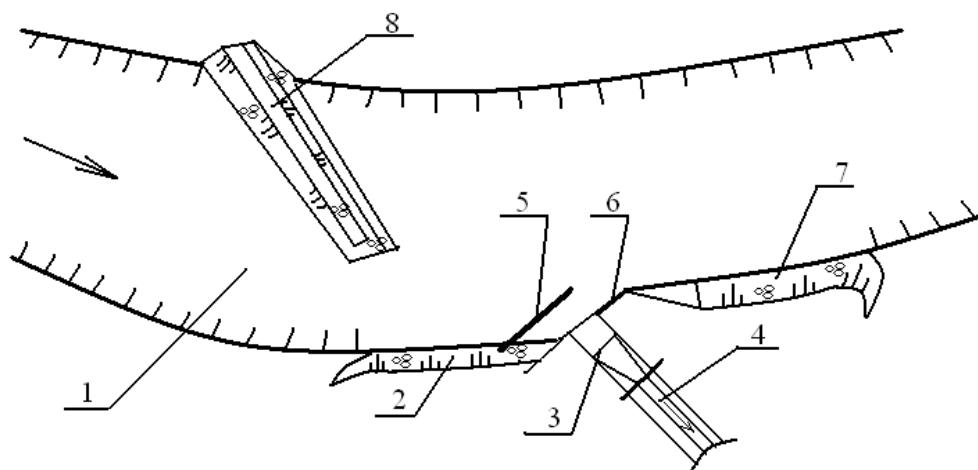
Схема размещения элементов бесплотинного водозаборного гидроузла на устойчивых участках русла: 1 – русло реки; 2 и 7 – береговые укрепления; 3 – водоприемник; 4 – отводящий канал; 5 – донный порог; 6 – экранирующая стенка; 8 – струенаправляющая шпора
